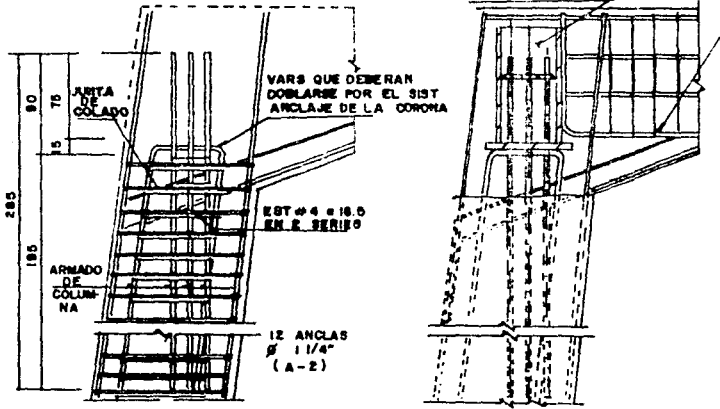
ARMADO PARA EL SISTEMA DE ANCLAJE DE APOYOS PASIVOS.
